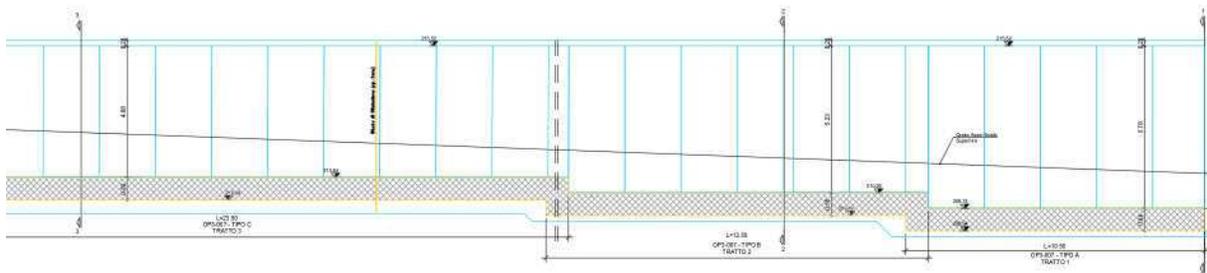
Muro OP3-008 - Stralcio prospetto
